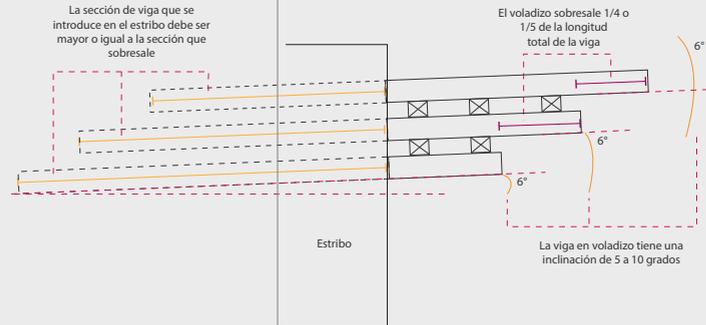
Principio de vigas en voladizo. Elaboración propia, 2021
